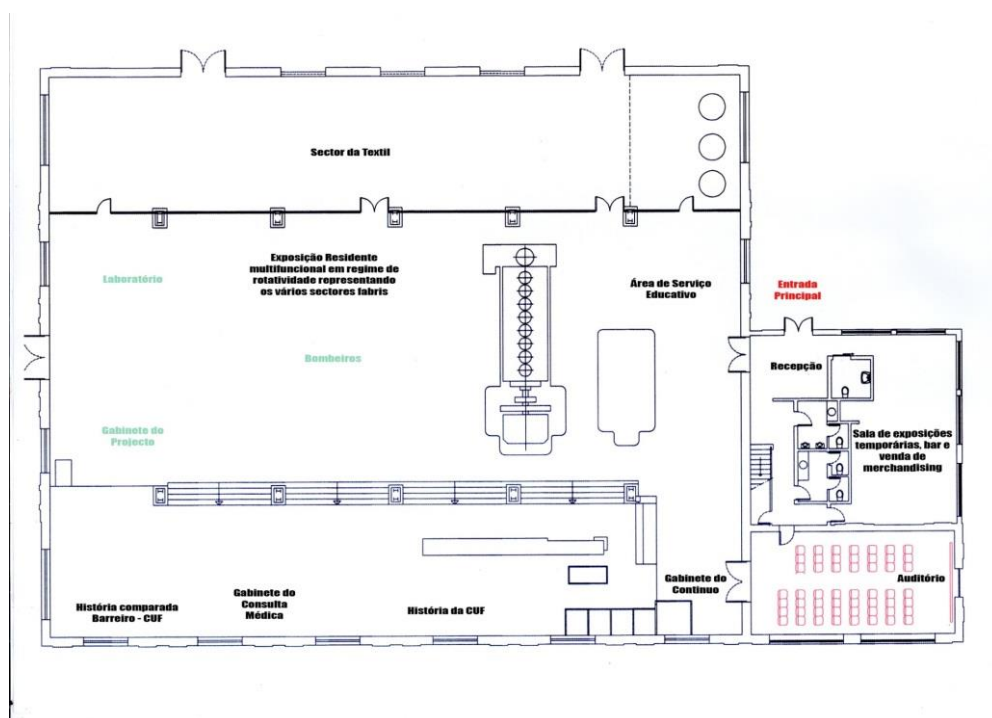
Projeto – Arquitecto Varandas Monteiro. Planificação da exposição permanente, 2008.
